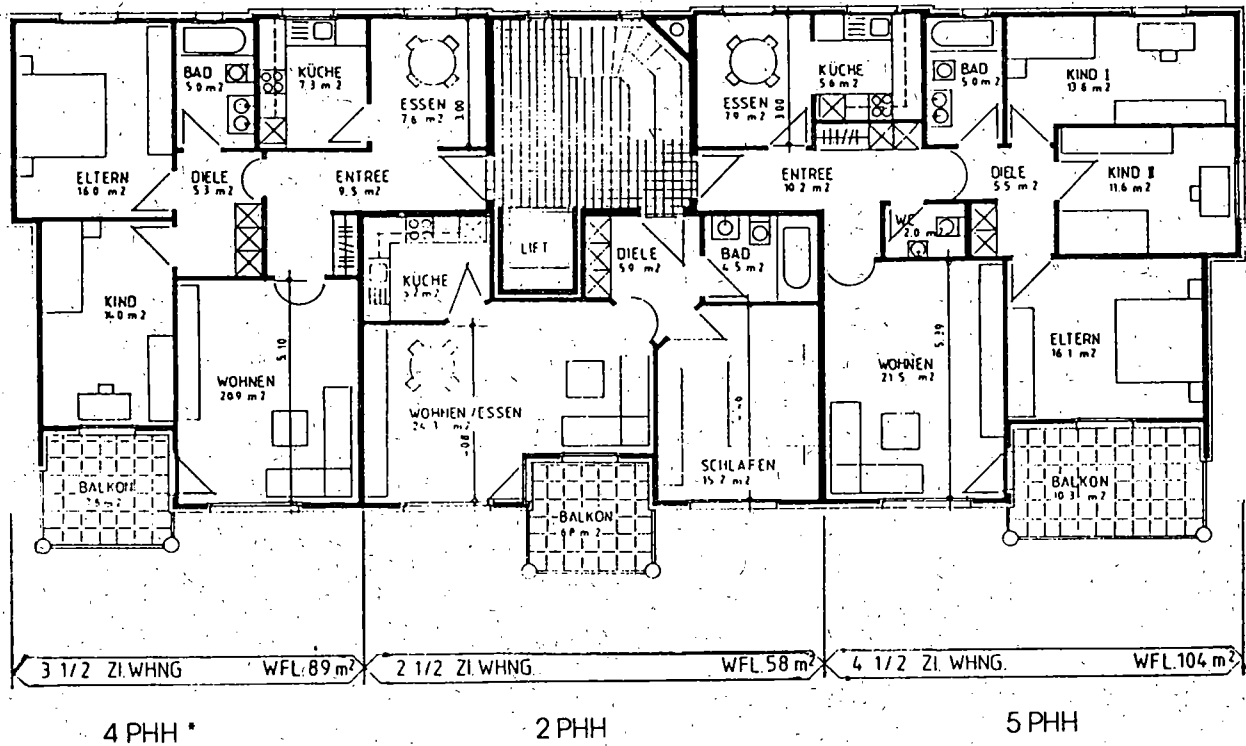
Grundriss Erdgeschoss, 1. und 2. Obergeschoss
